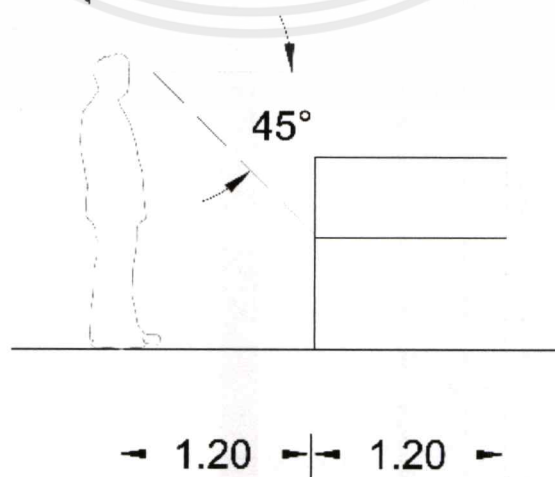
16 พื้นที่นิทรรศการประเภท Wall board
